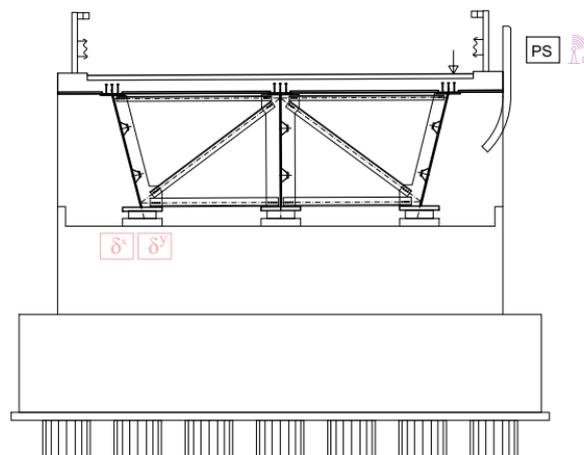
Ubicazione sensori su spalla (es. viadotto Tevere)
